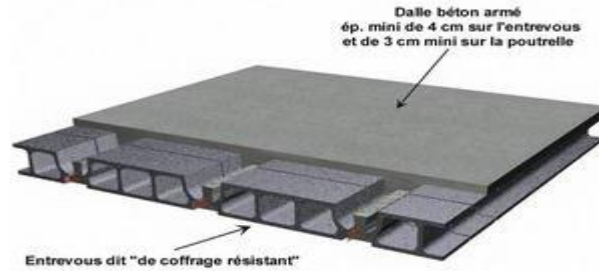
Les éléments constructifs d'une dalle en hourdis (corps creux)
